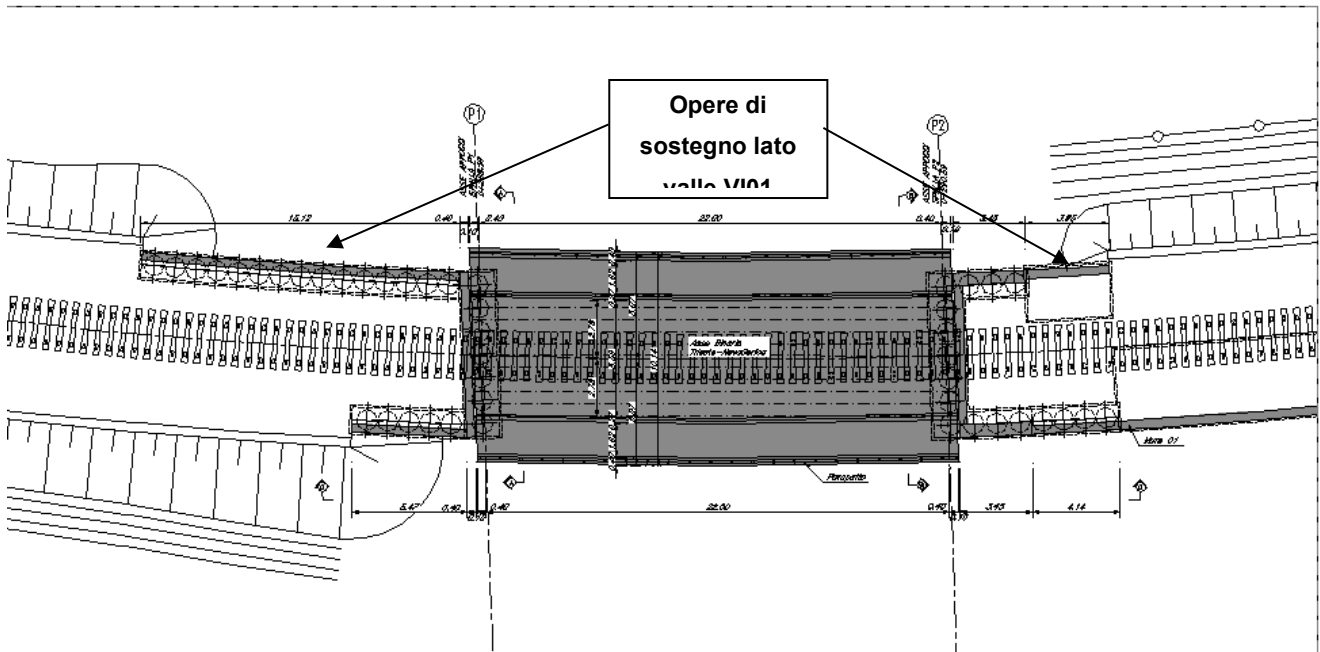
10: Planimetria con ubicazione dell'opera di sostegno lato valle.
